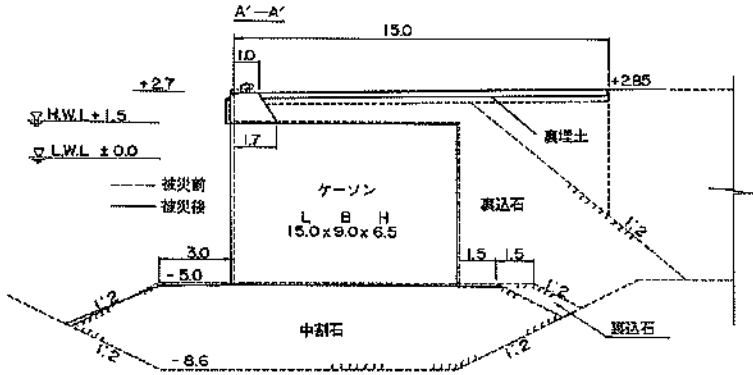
被災状況図 (A'-A'断面) (漁港埠頭, ①東側岸壁(-5.0m))
